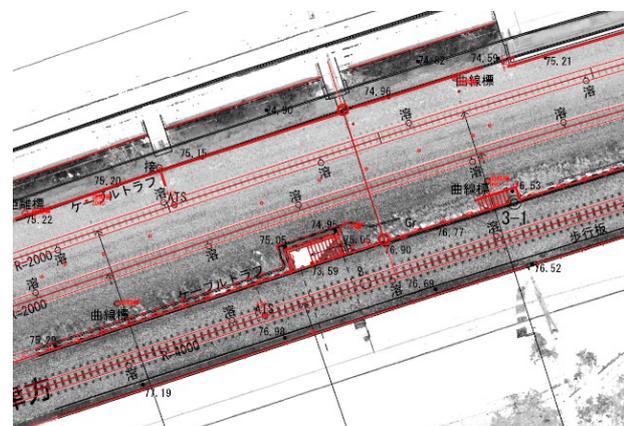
点群図化素図，実測平面図，反射強度オルソ重ね図
